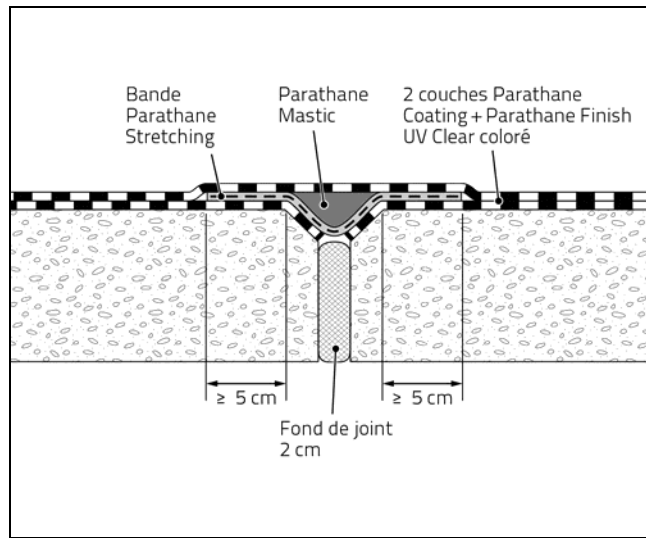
Joint de dilatation pour terrasse accessible hors dalle sur plots
